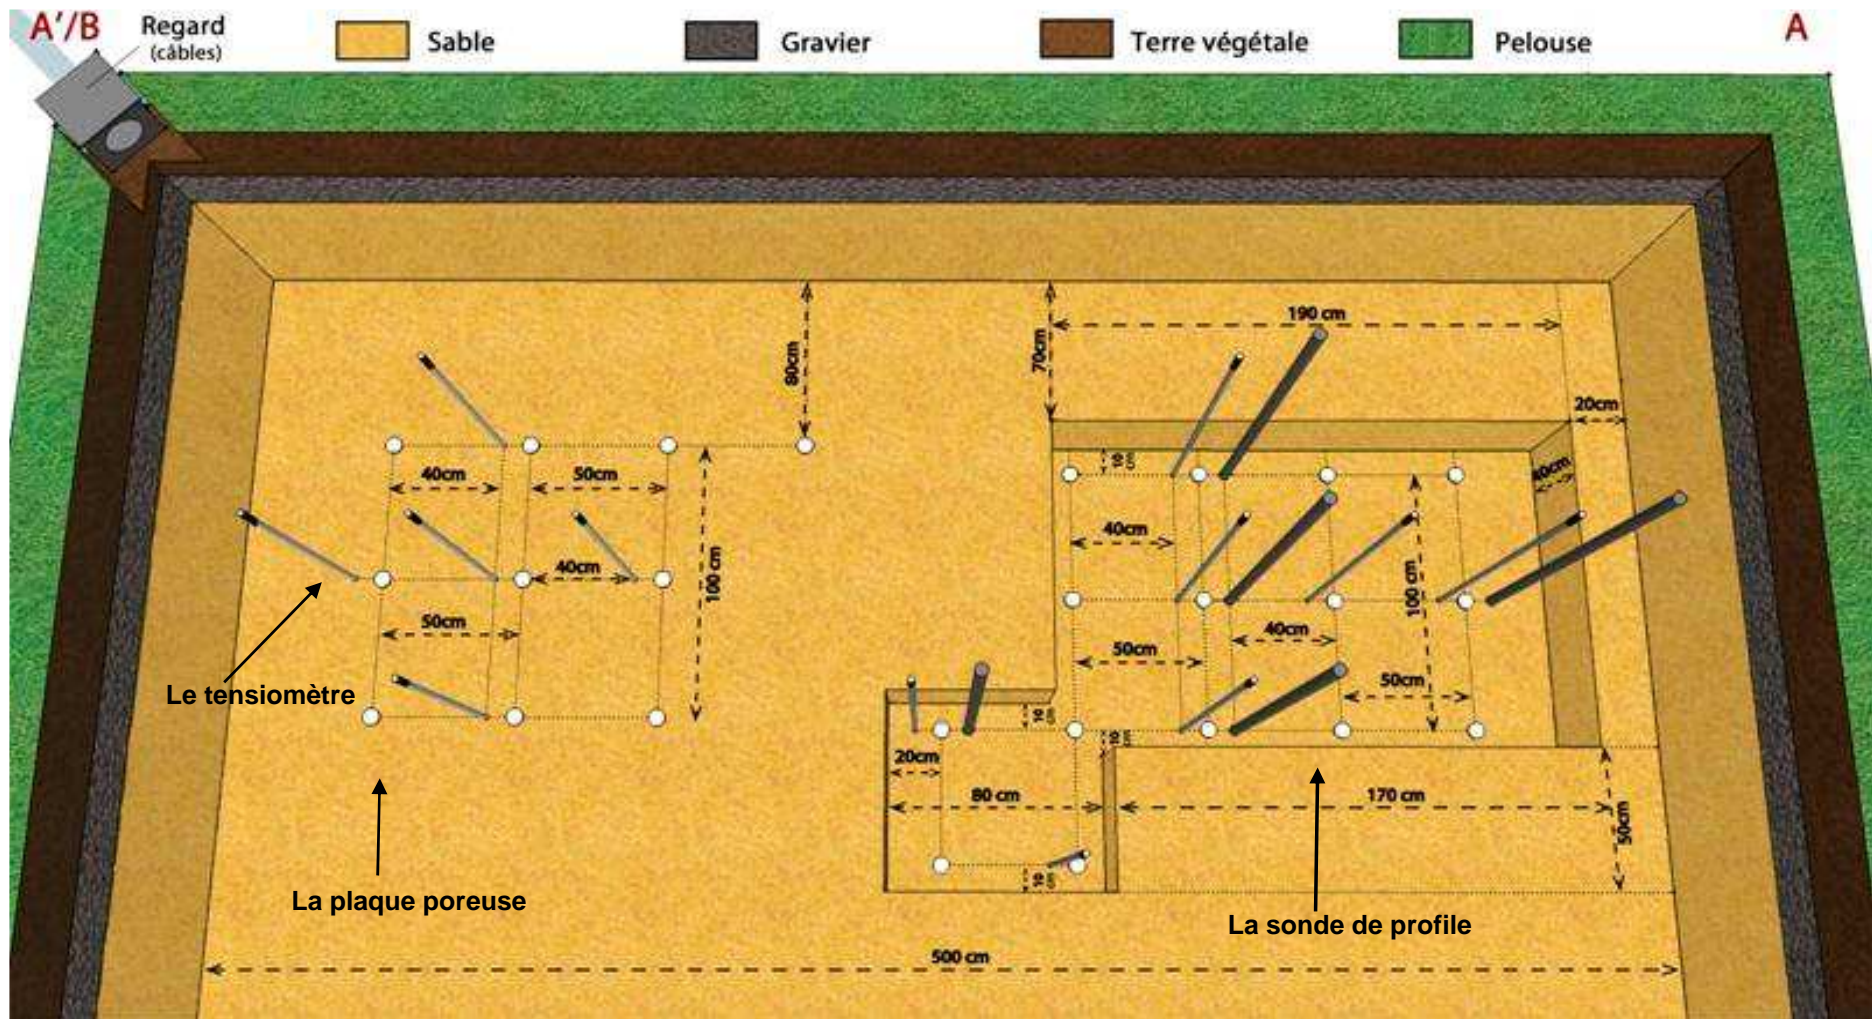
Plan d'installation des capteurs au fond de la fouille du futur massif filtrant
